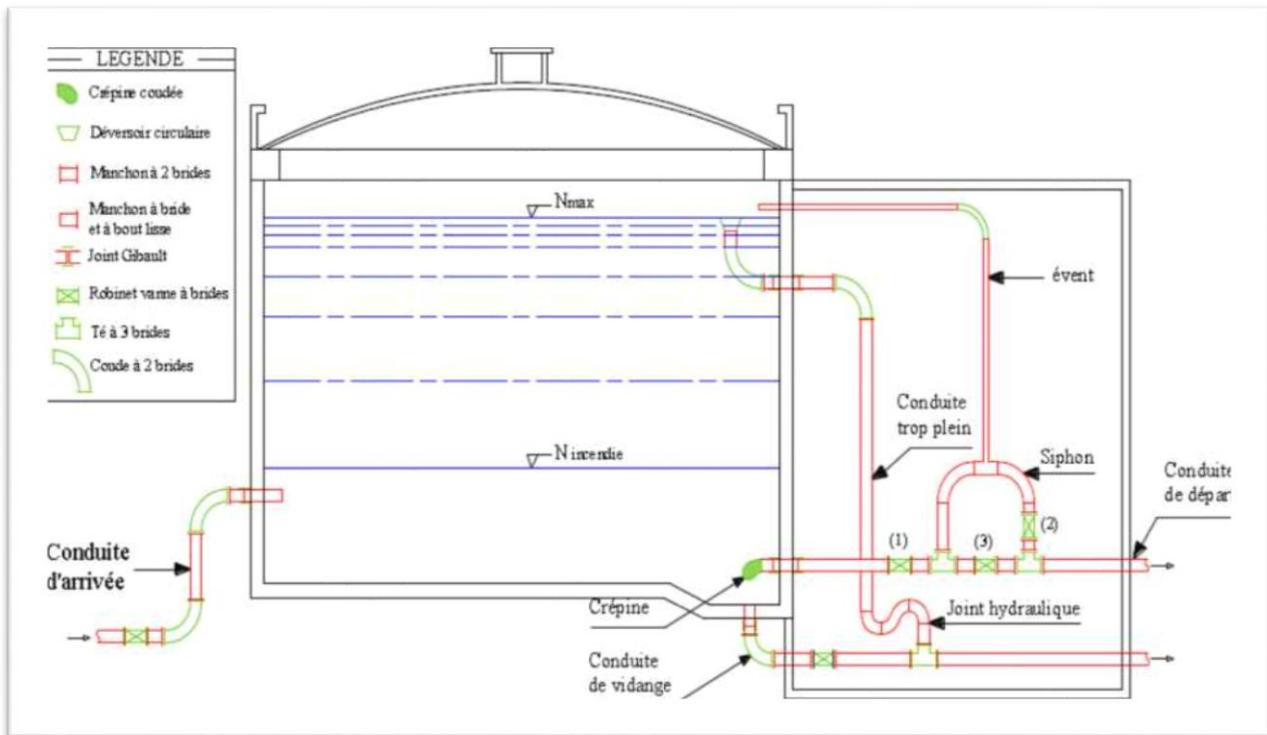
Coupe transversale d'un réservoir semi-enterré [5]
